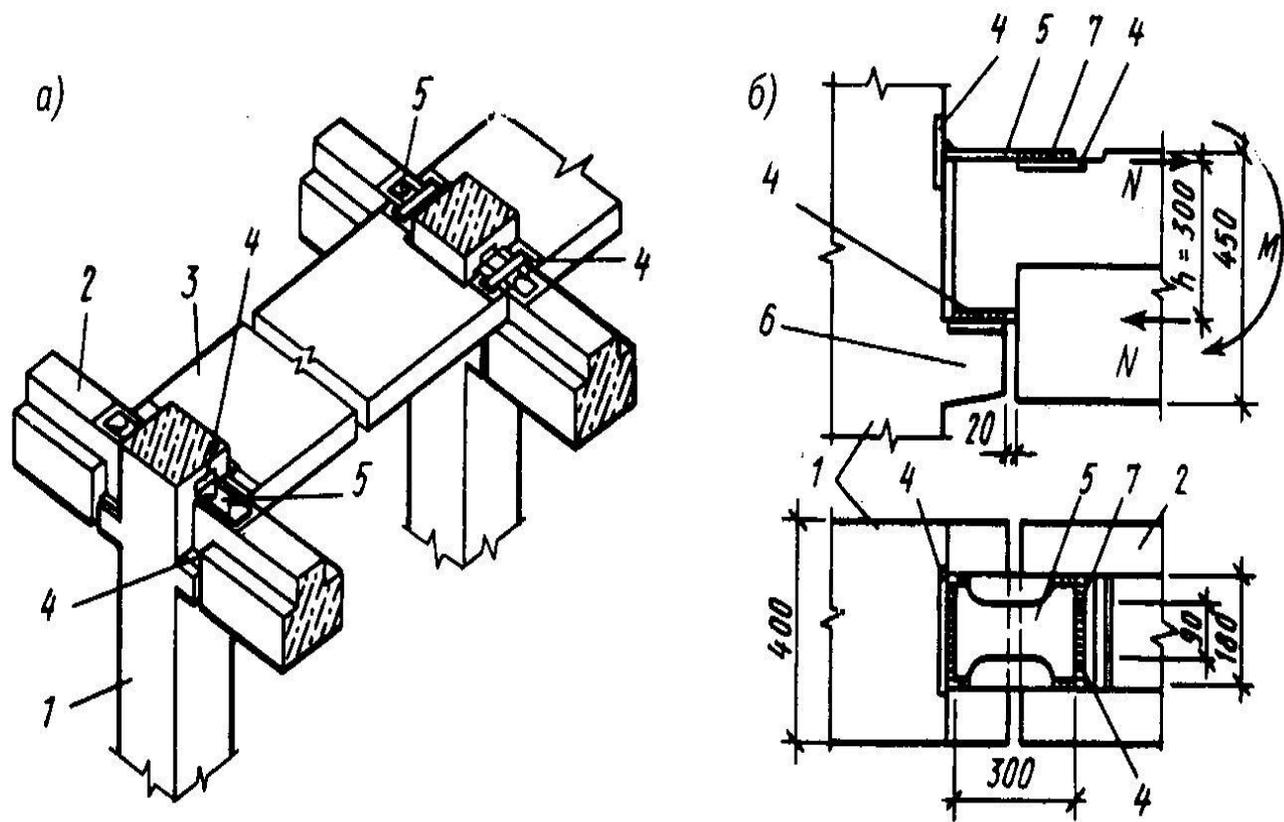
Узел опирания ригеля на колонну в унифицированном каркасе:
